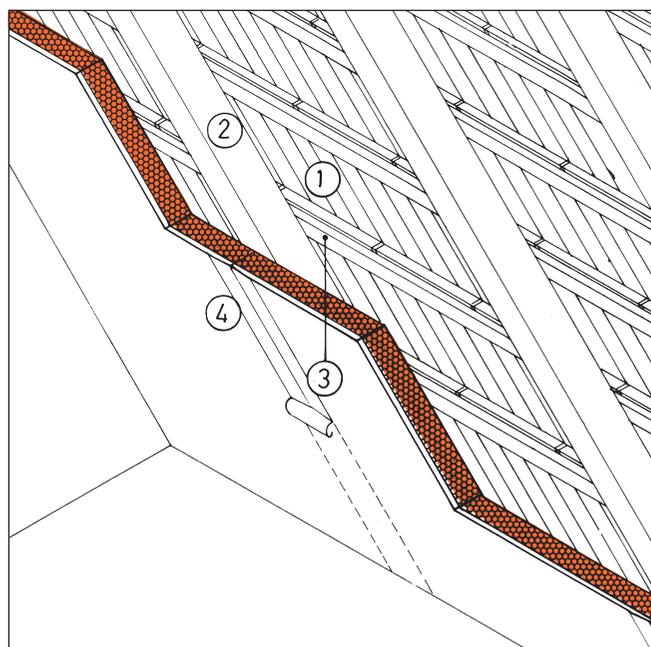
Isolamento di tetto a falde sotto orditura.
